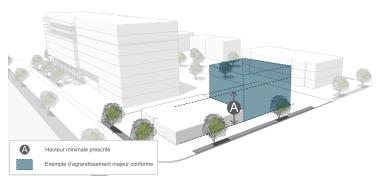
Agrandissement majeur d'une construction dérogatoire à la hauteur minimale
